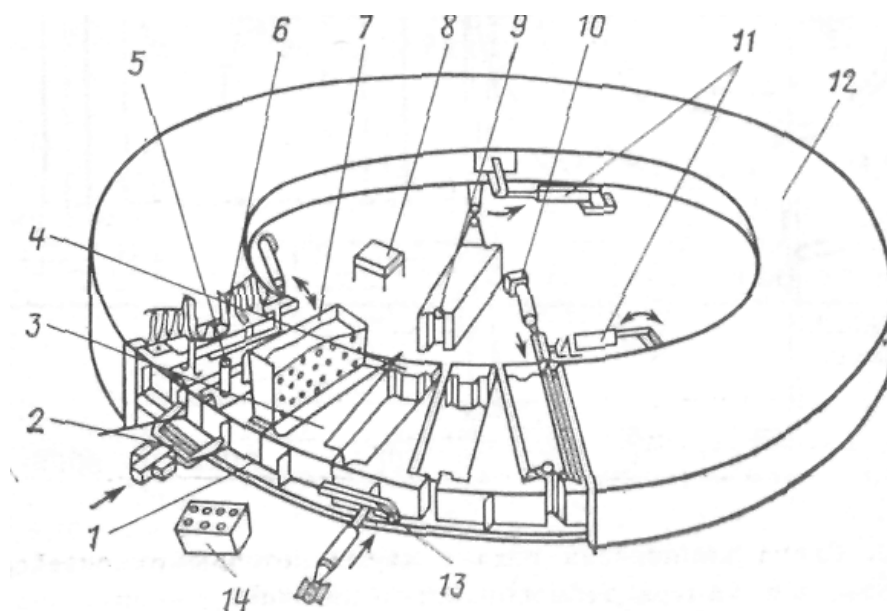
Схема роторной конвейерной линии с клиновыми формообразующими элементами для изготовления блоков стен подвалов:
